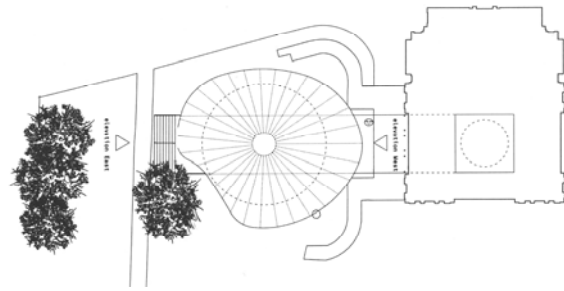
Planta de implantação, pavilhão de Rem Koolhaas e Cecil Balmond, 2006.
